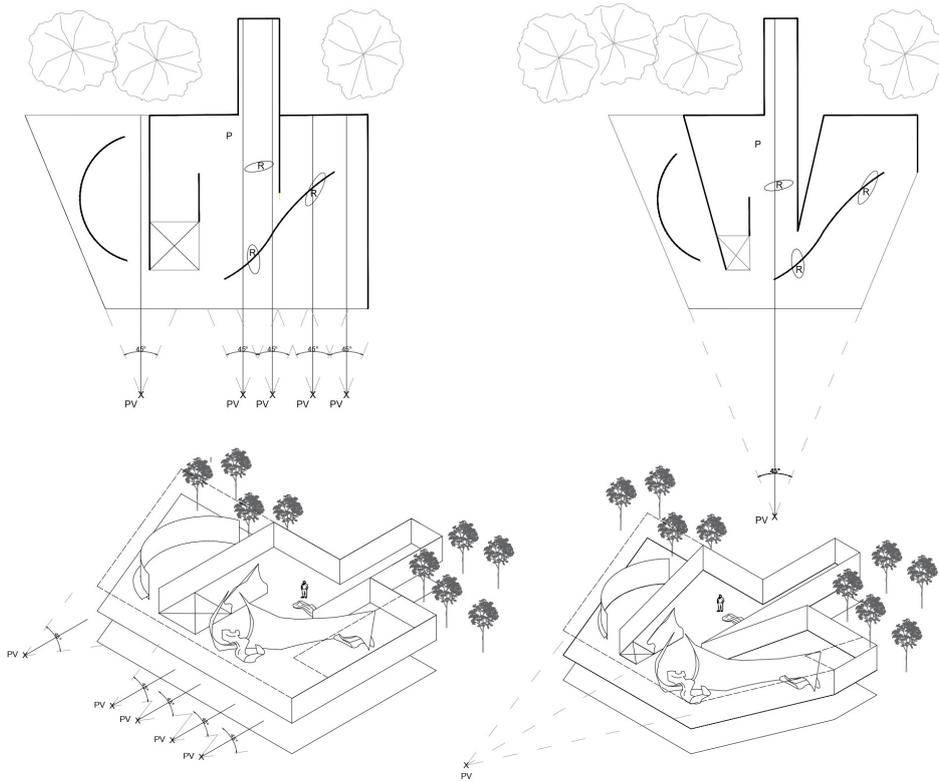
; Restitución de Planta y Ambiente de Ilustración 1 (izquierda: según vistas parciales; derecha; según vista central). Elaboración propia.
